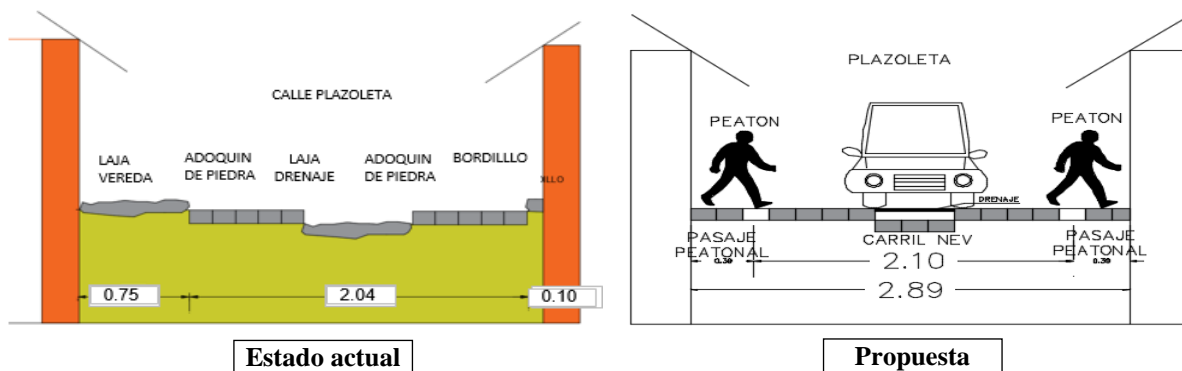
Propuesta de la sección transversal para la calle Plazoleta
